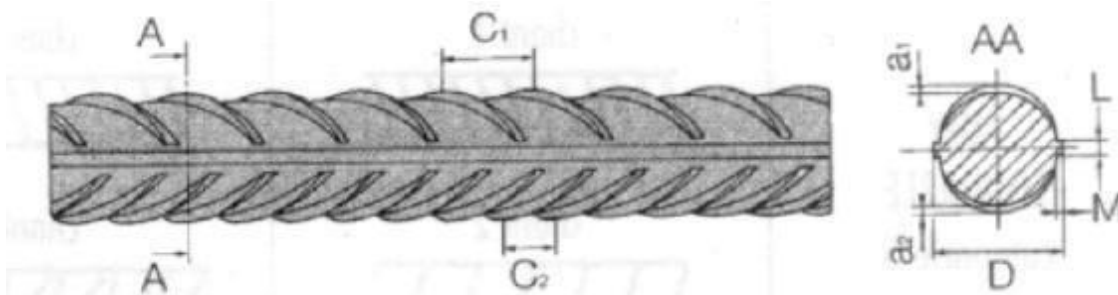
Vue de face et coupe transversal d'une barre HA
